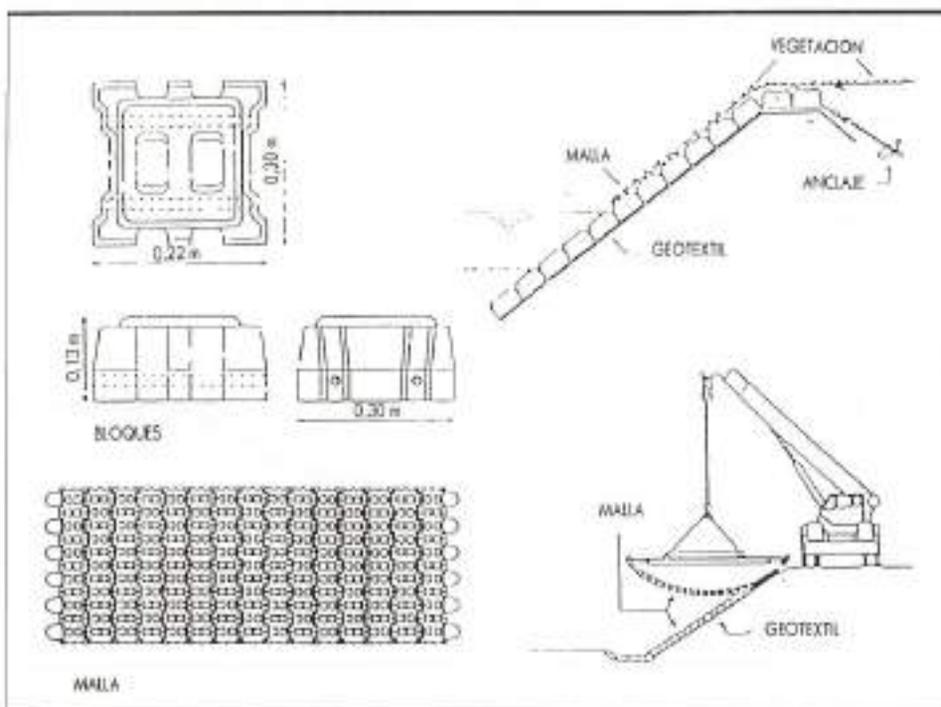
Protección de márgenes con piezas de hormigón prefabricadas.
